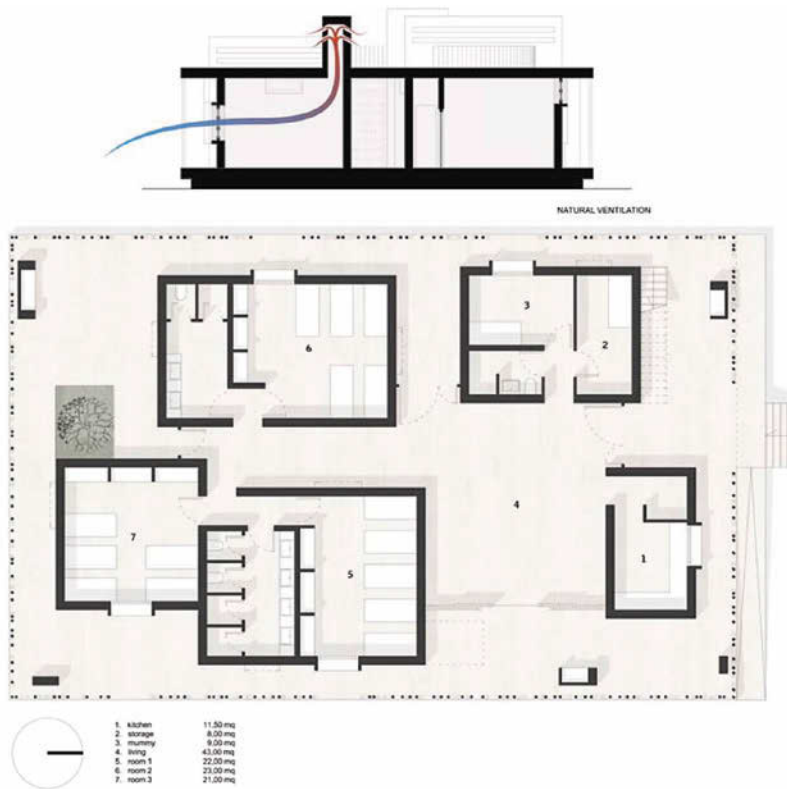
/ Casa Rana. Esquema del sistema de ventilación. Planta baja en la que se aprecia la organización de volúmenes que generan espacios intermedios bajo una única cubierta con galería perimetral.
